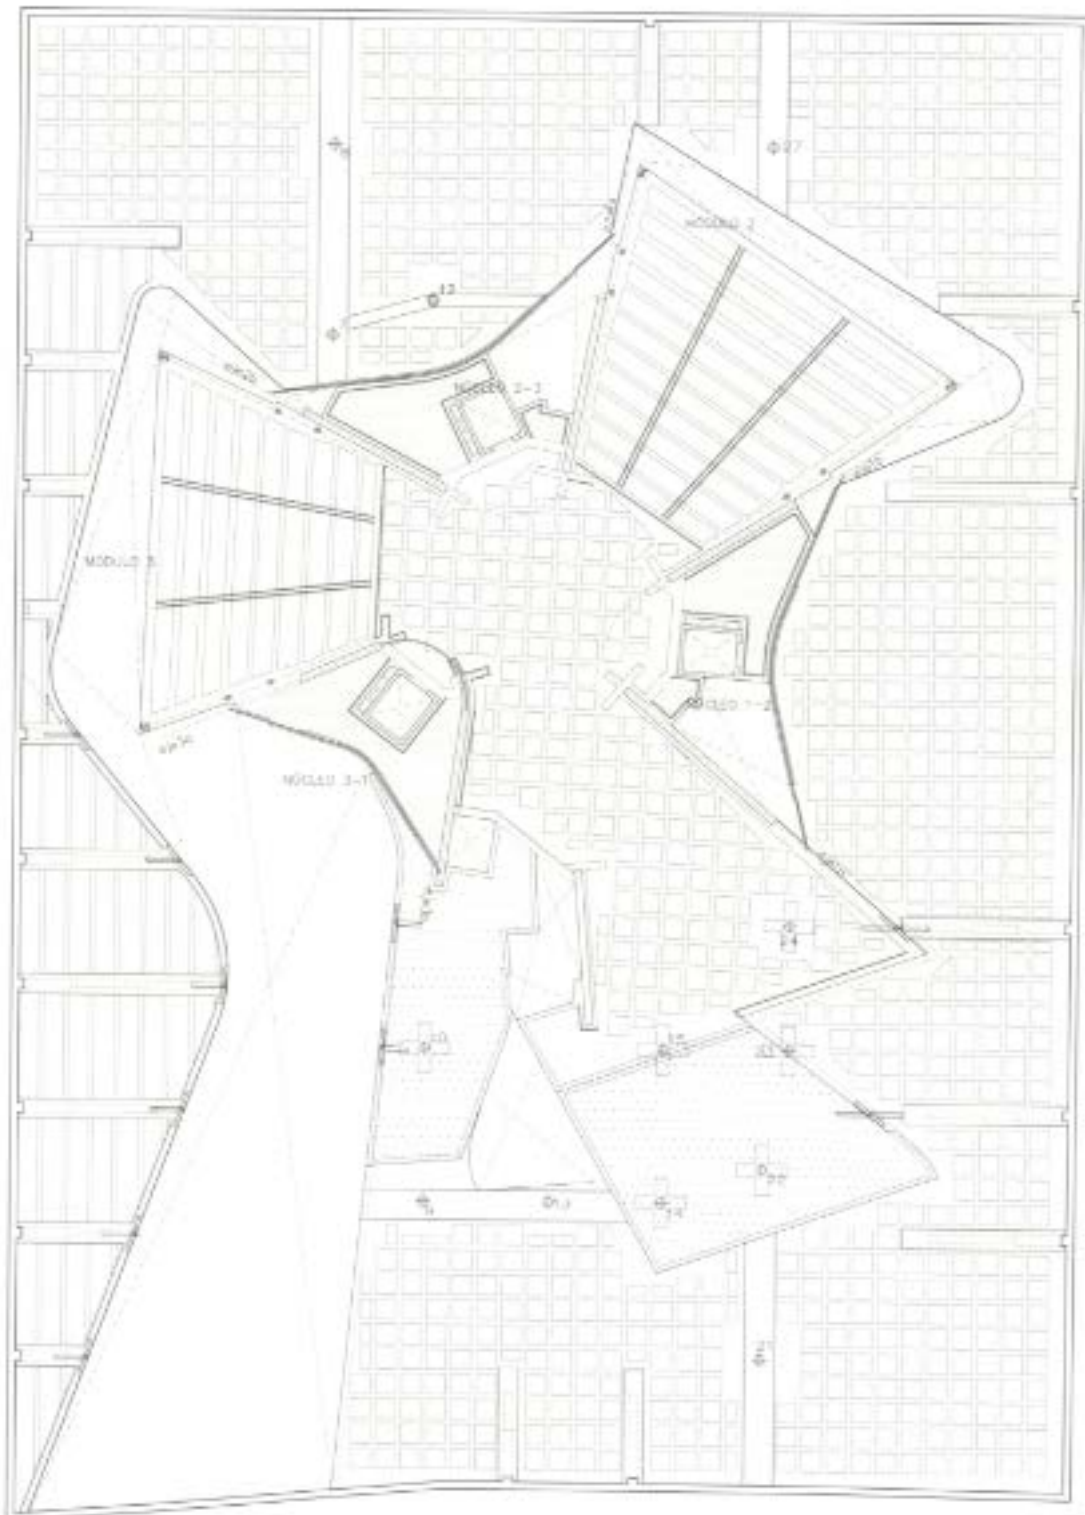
Detalle de la disposición de los forjados en la planta de encuentro de la torre y el sótano. Documentos de Arquitectura nº 60. Revista del Colegio de Arquitectos de Almería.
